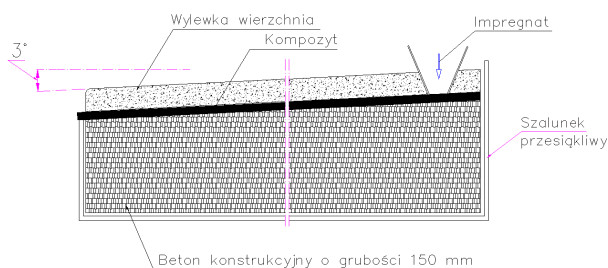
Schemat zastosowania kompozytu w izolowanej konstrukcji betonowej
